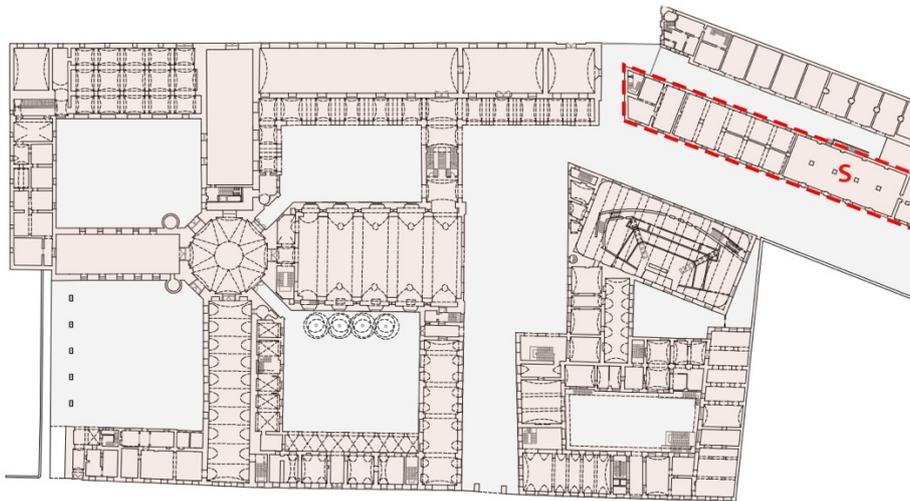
planimetria con evidenza edificio S - elaborazione personale
